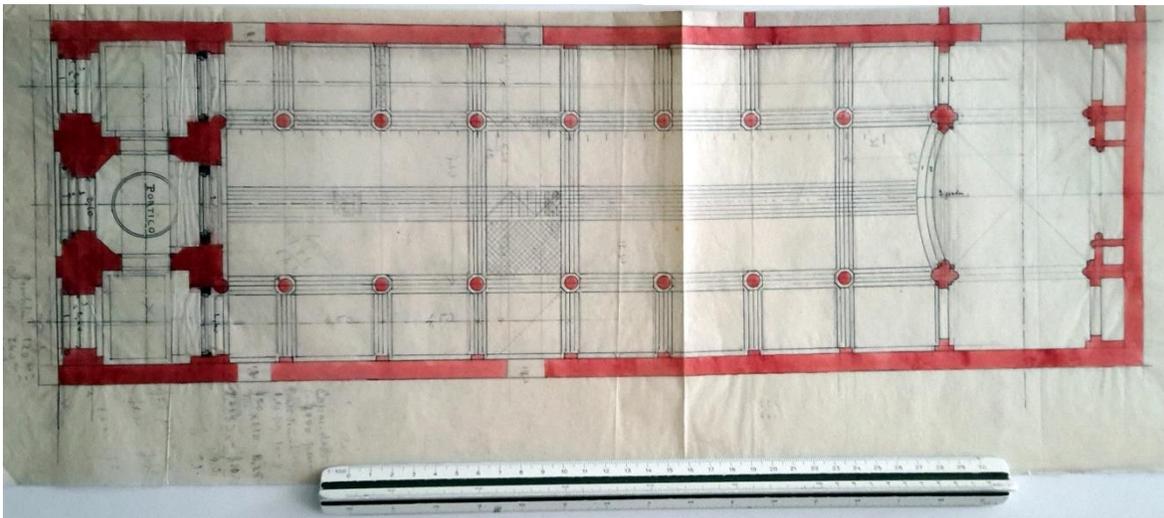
Planta de arquitectura dibujada por E. Joannon. Sin fecha. Fuente: Archivo Joannon Rivera.
